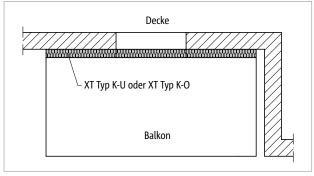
Schöck Isokorb® XT Typ K-U/K-O: Balkon bei Fassadenvorsprung
